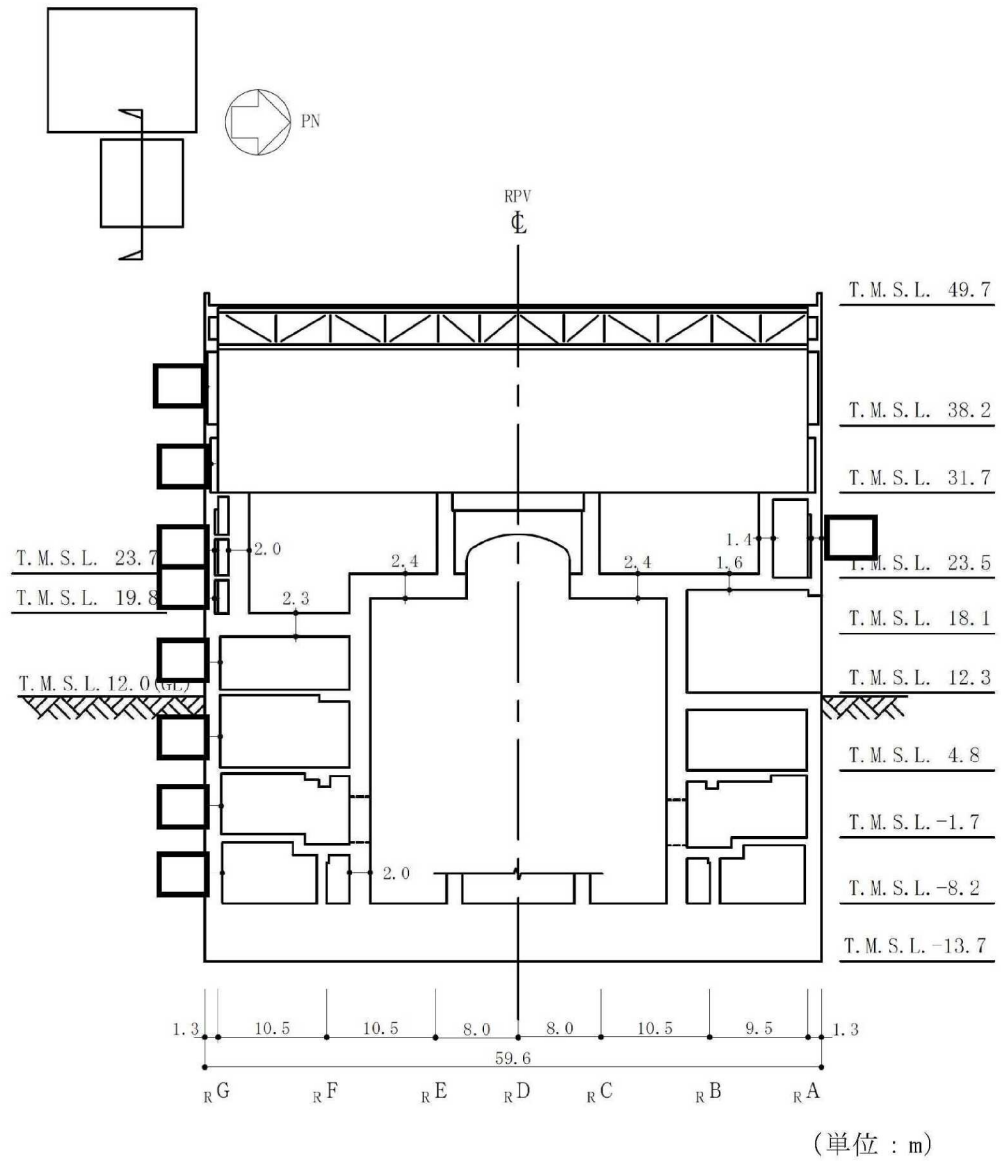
原子炉建屋の概略断面図 (EW方向) (2/2)
